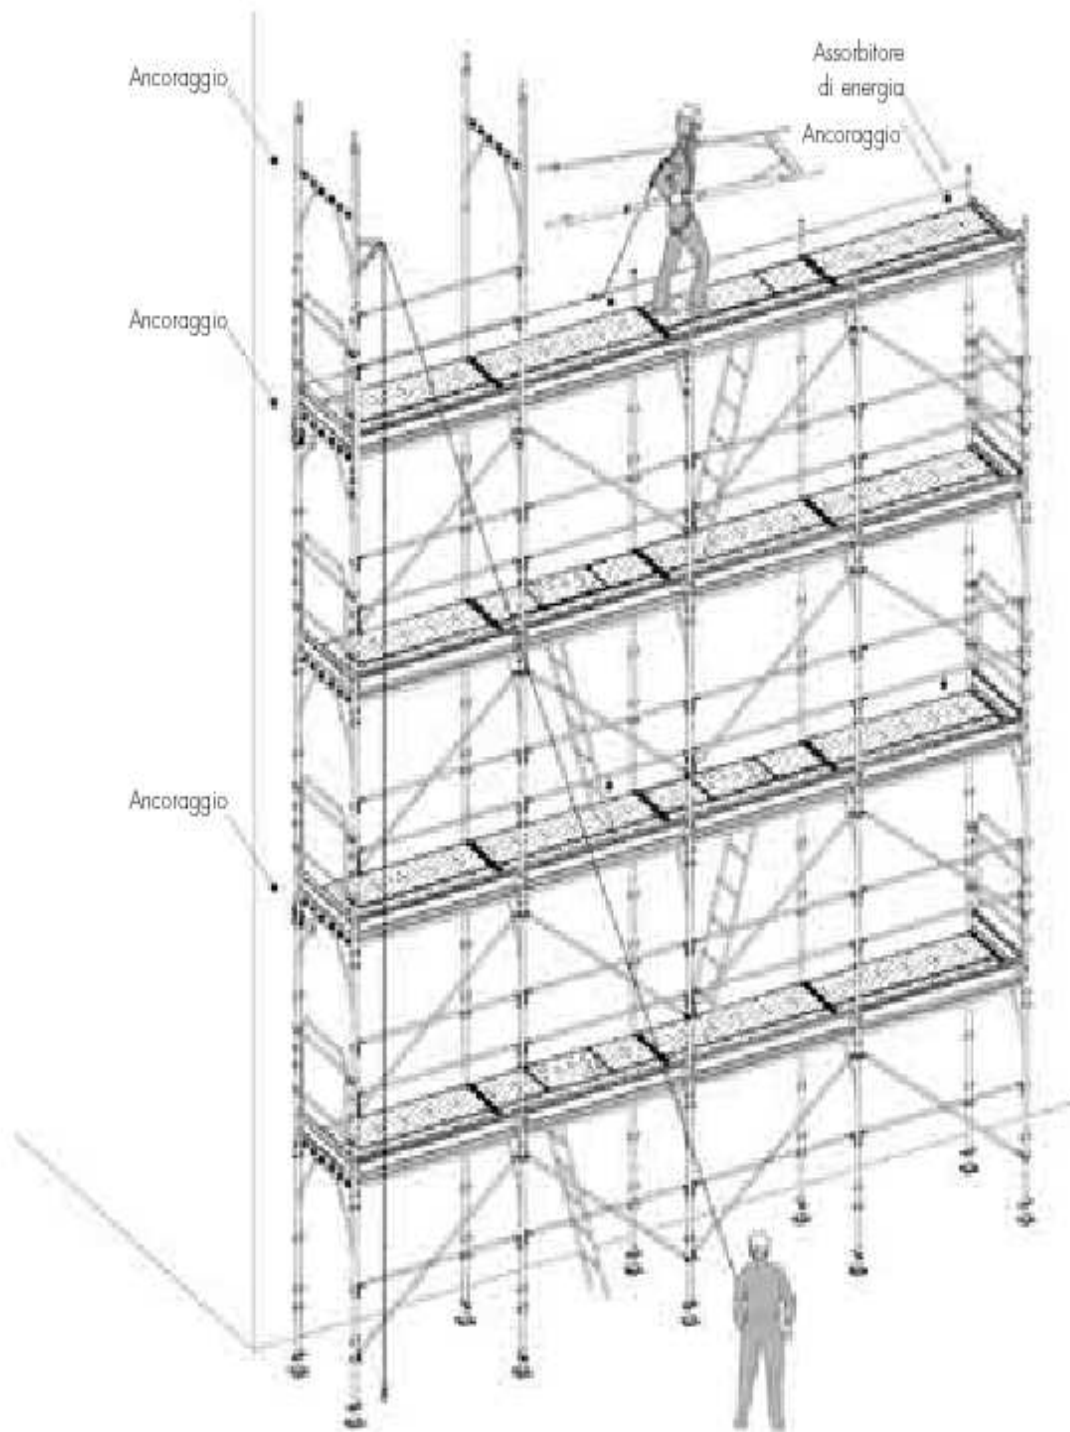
Esempio di montaggio con organo di sollevamento al piano di assemblaggio
